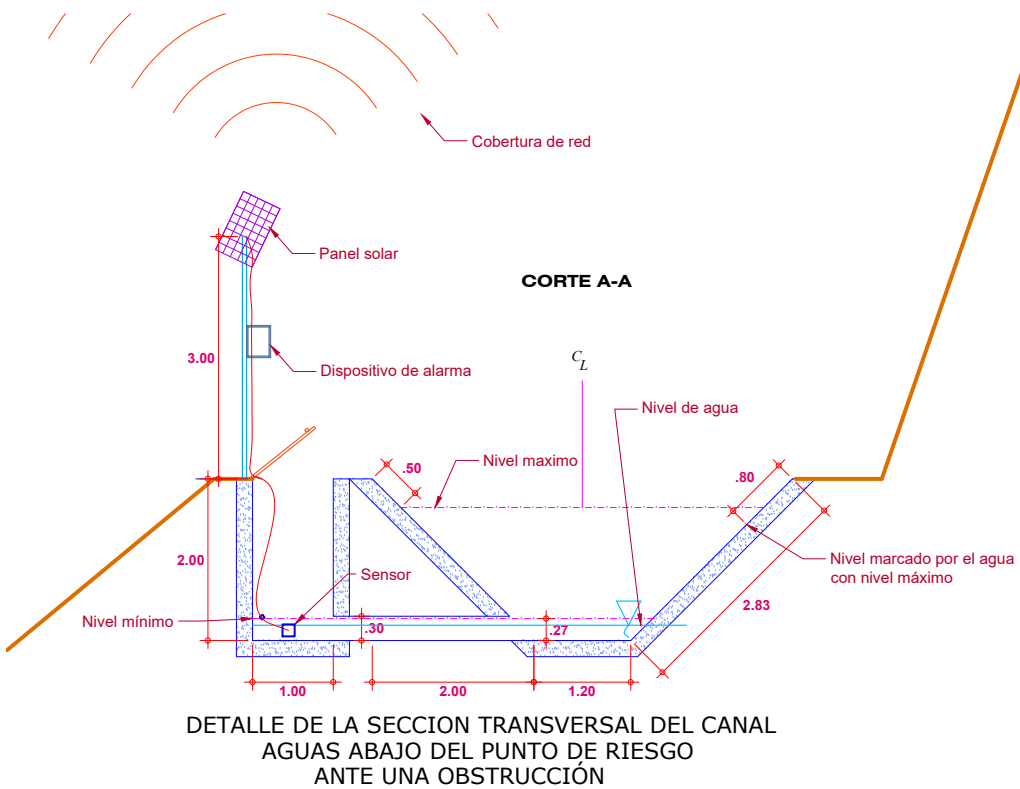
Esquema de la sección transversal del canal con el sistema de alarma ante una posible
